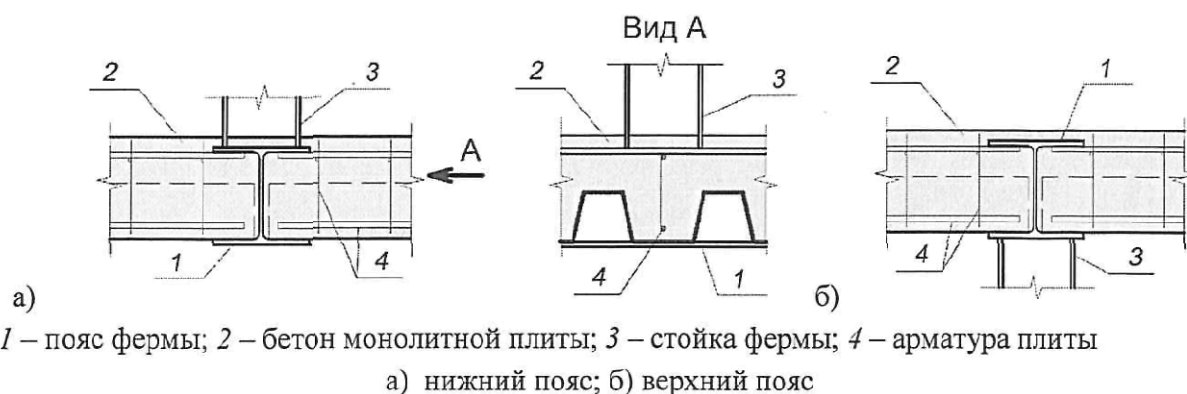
Схема узла сопряжения монолитного перекрытия по профилированному настилу с поясами ферм
